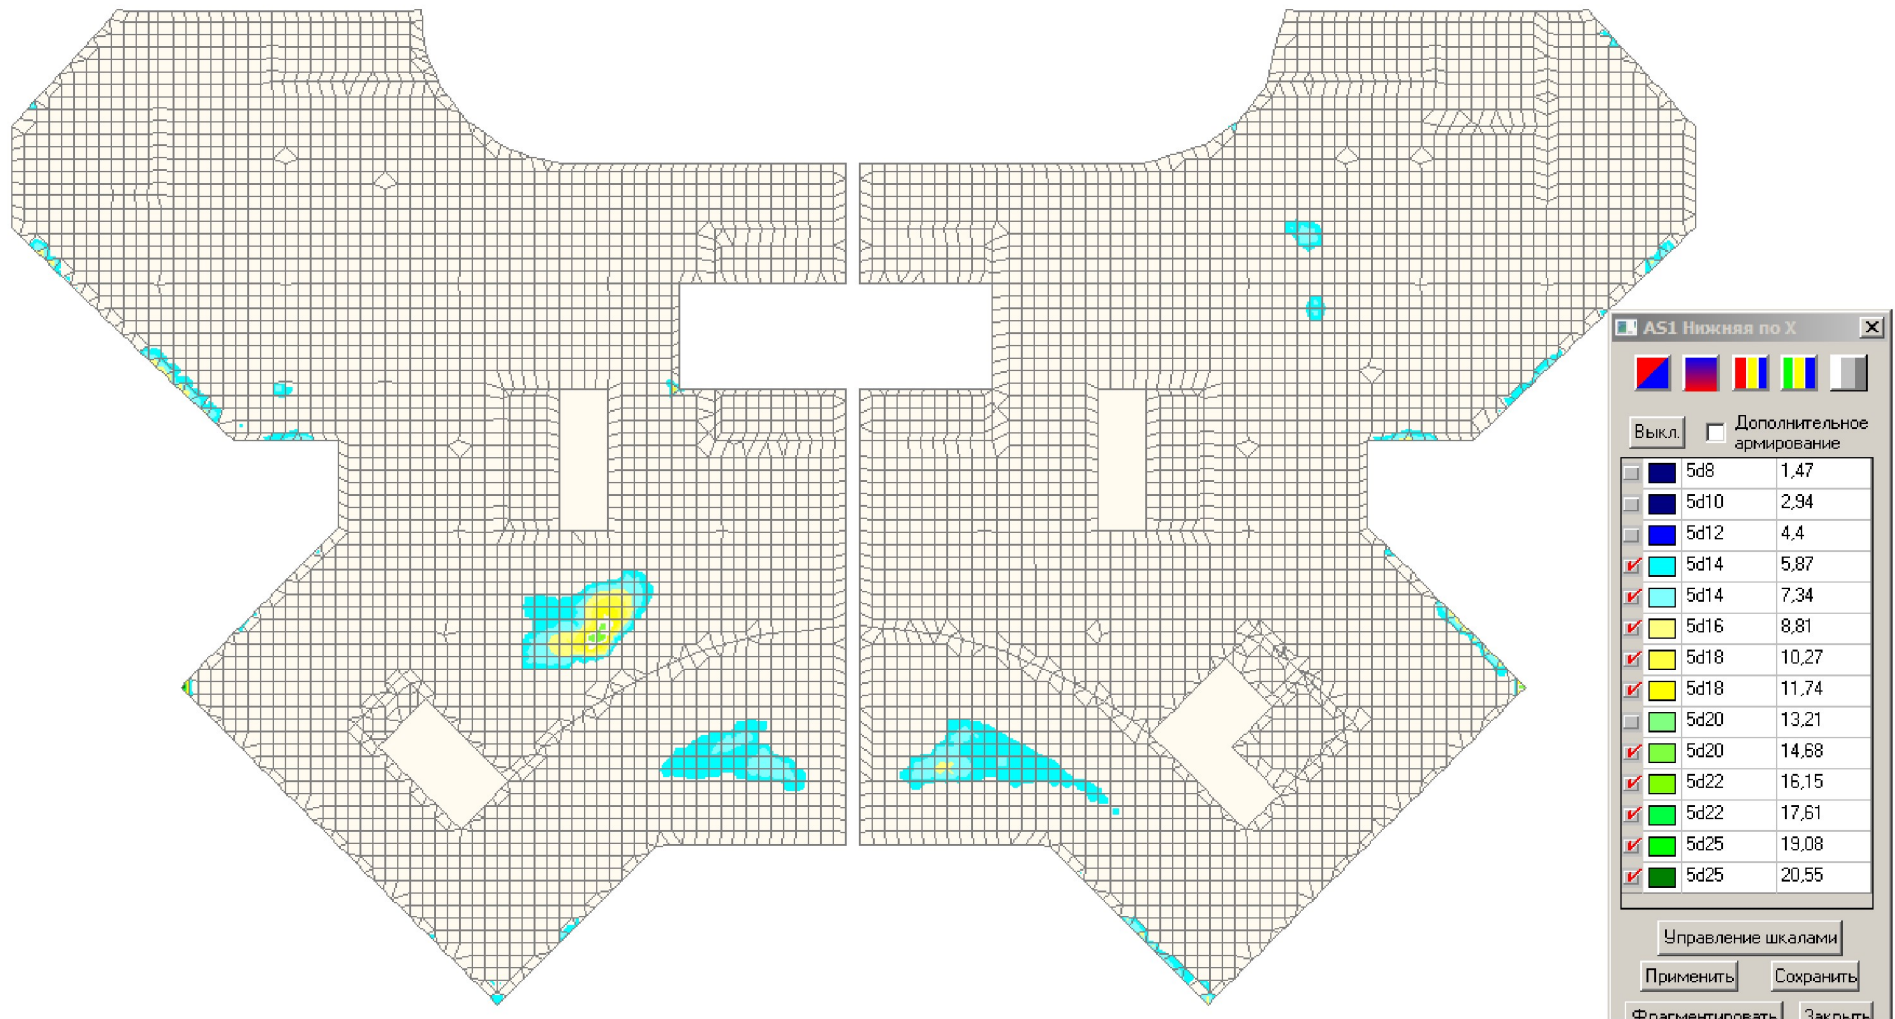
Армирование плиты перекрытия на відм. 0.000 (нижнє X)
